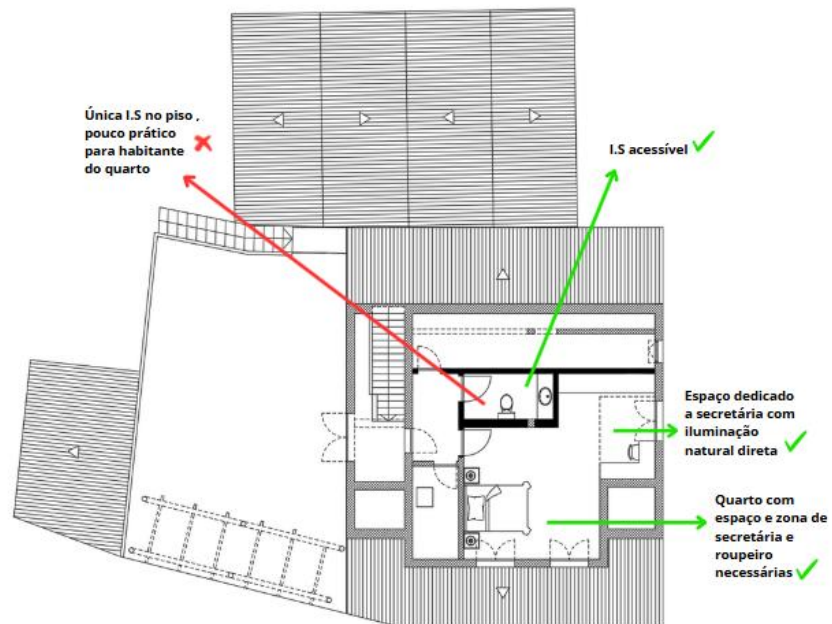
Análise de plantas esboço, proposta 3, piso 1
